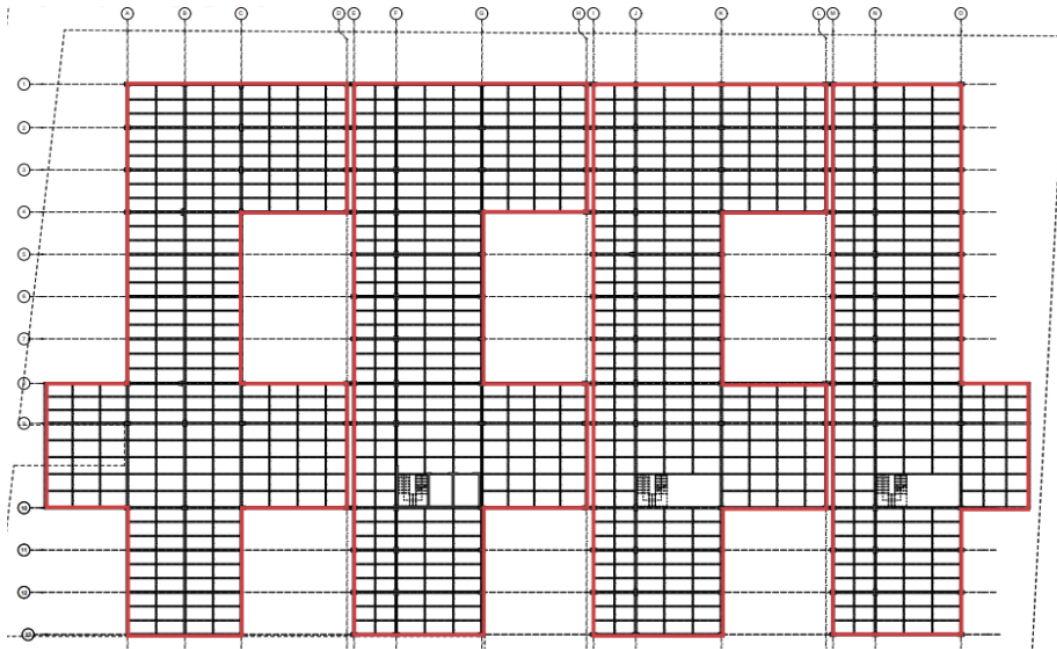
Planta constructiva segundo nivel. Elaboración propia
